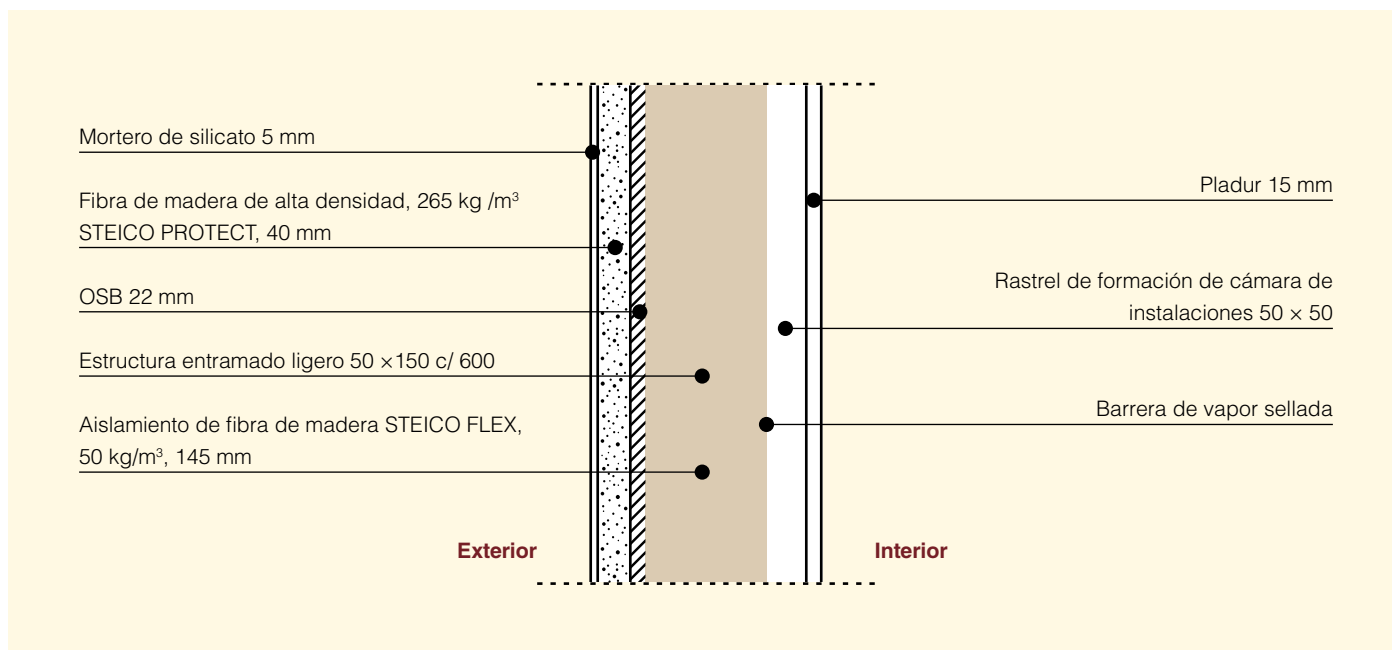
Sección en alzado de la fachada de la vivienda. Fuente: House Habitat.
